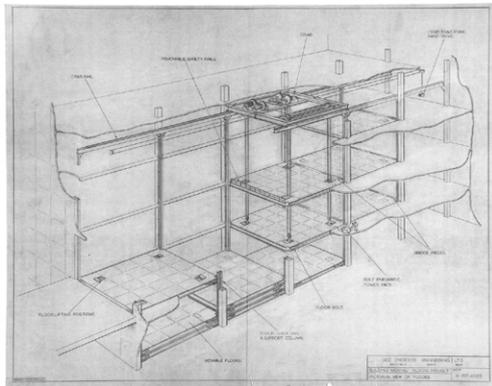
| Proyecto de la Oxford Corner House que muestra el sistema de pisos móviles. Fuente: Imagen tomada del Canadian Center for Architecture.
